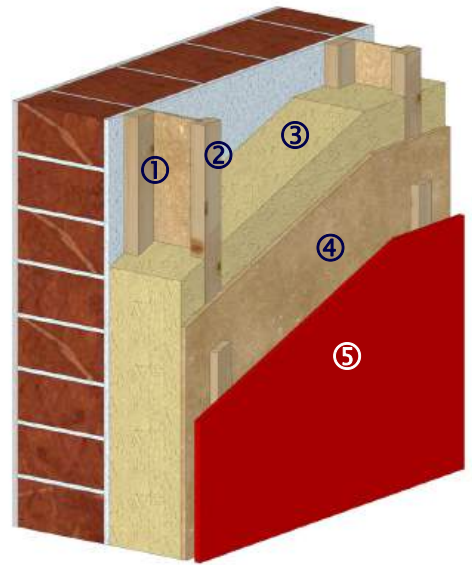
Erläuterungen zum Konstruktionsaufbau (Horizontalschnitte)
